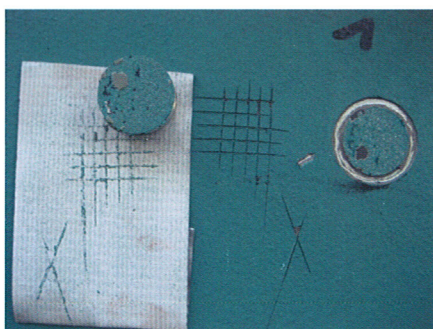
Dresdner Schwebebahn, Prüfstelle 1
